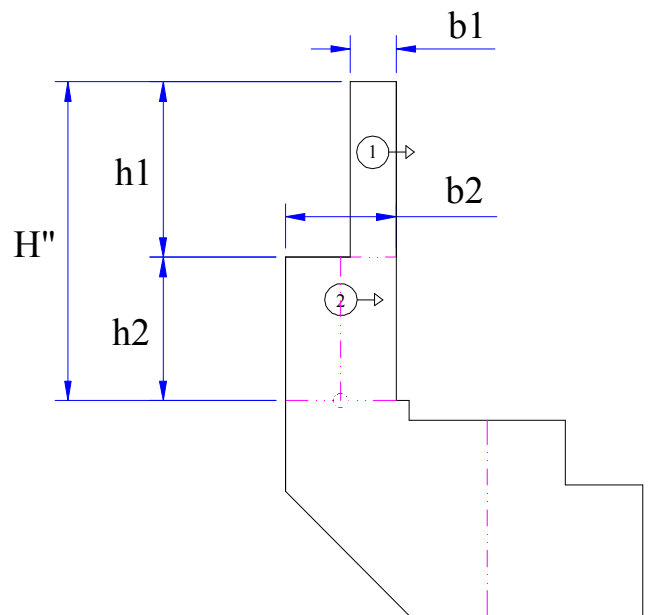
57 Tekanan Tanah Breast Wall Bawah
